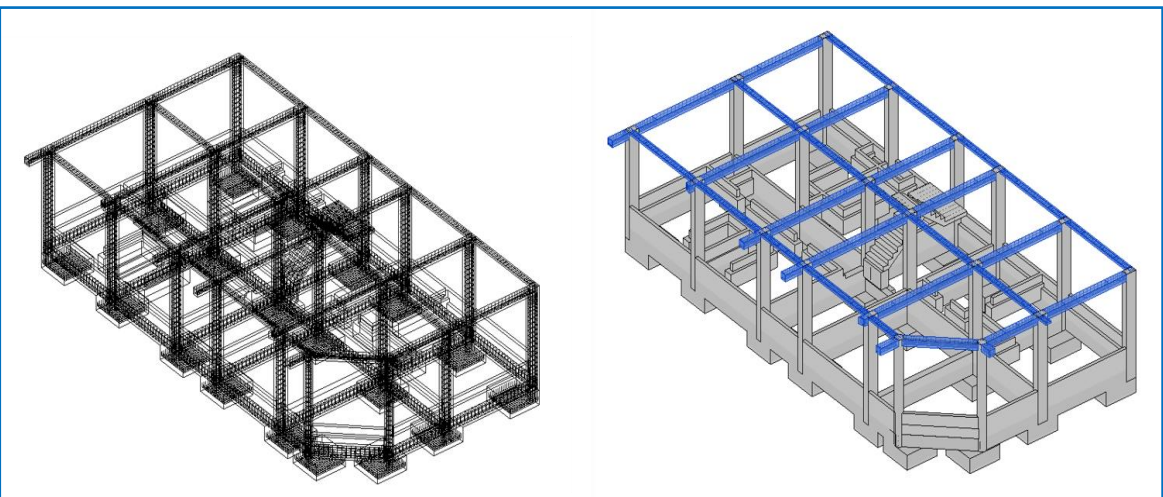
Vista 3D de cimentaciones en acero y concreto en Revit
